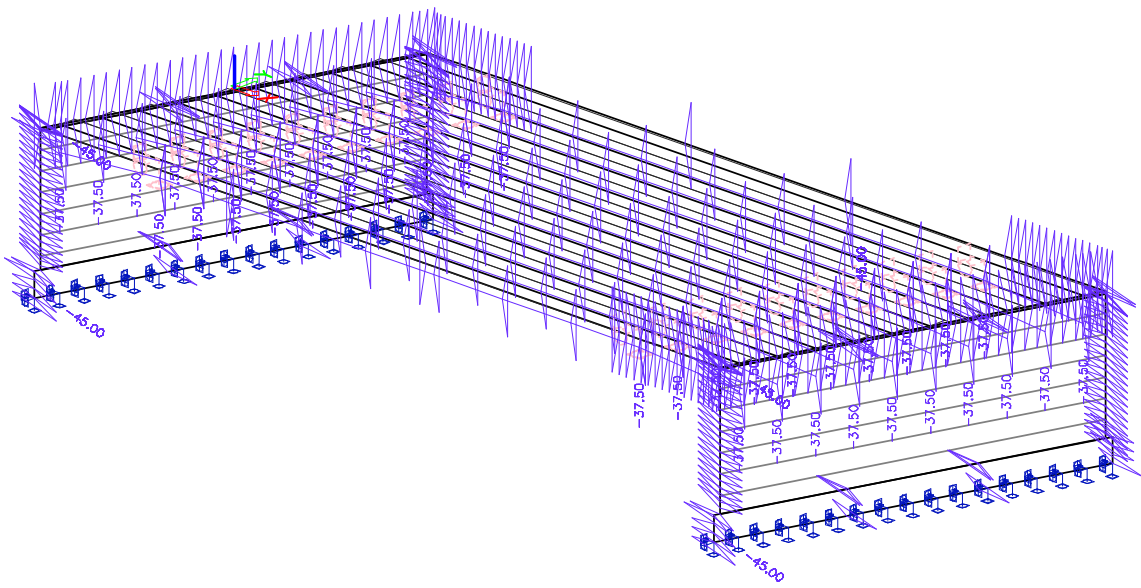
Zatížení dopravou – LM3 – 3000/240
